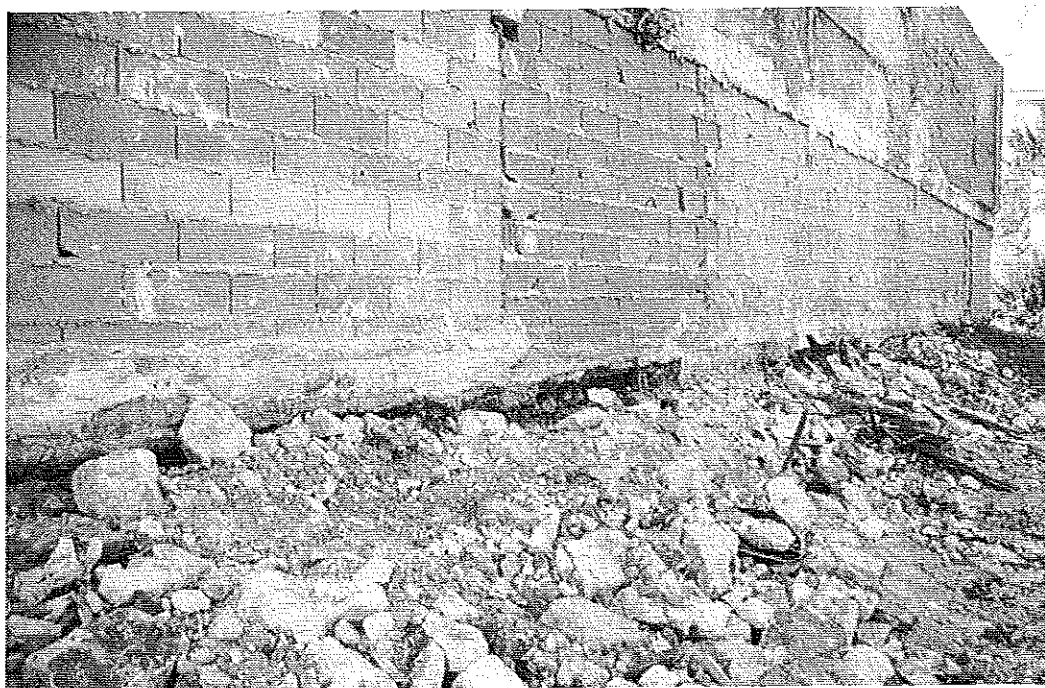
Bâtiment existant en limite, ouvrages de fondation dégagés sans protection. © J. Putatti
